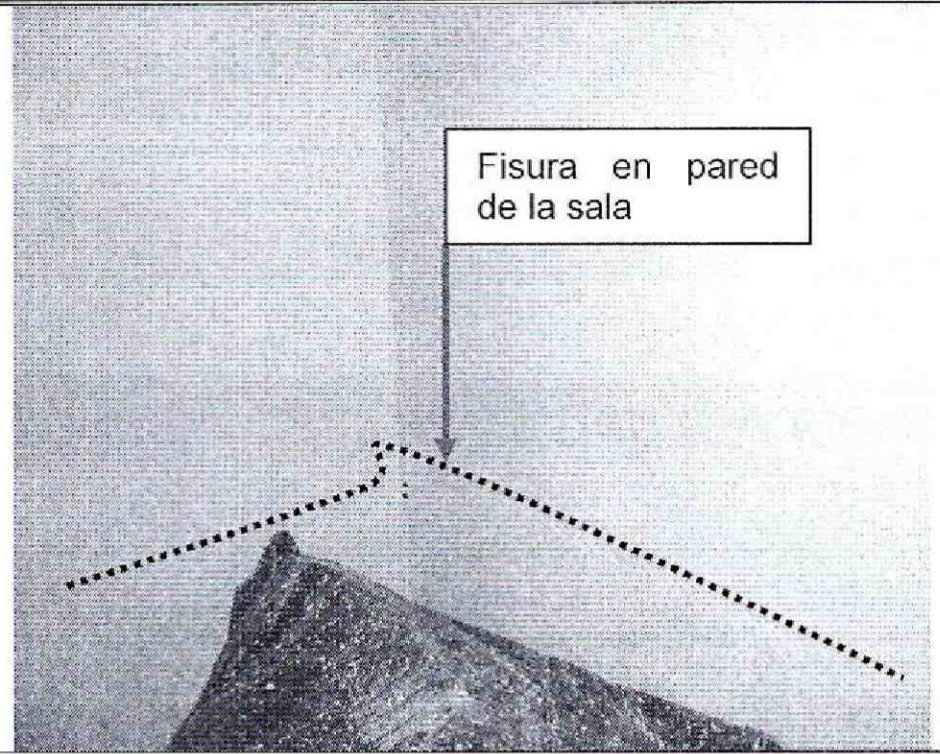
Fisuras en el costado norte del taller de costura.
